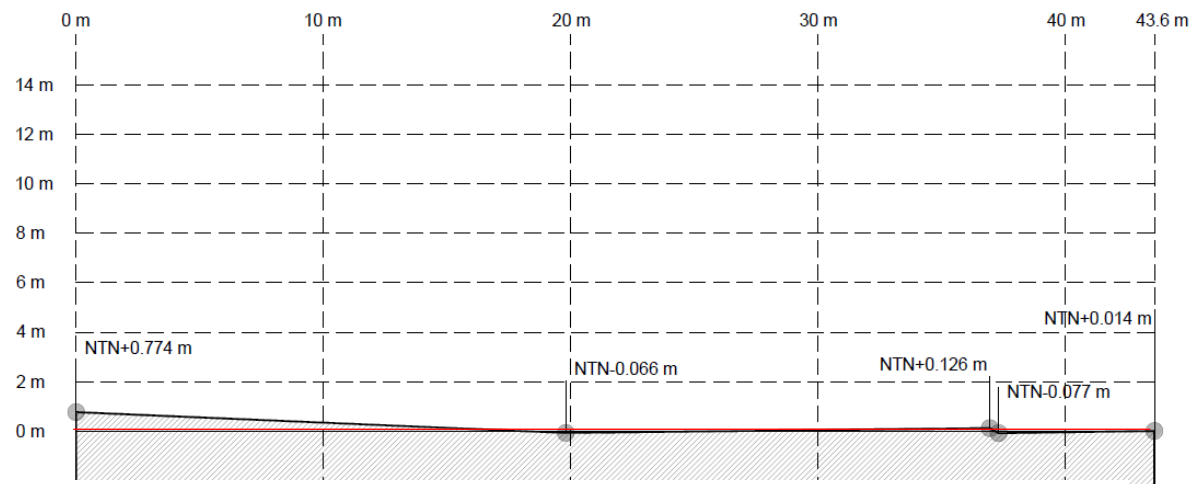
Corte transversal del predio (Google Earth/ Perfil de elevacion, 2012)
